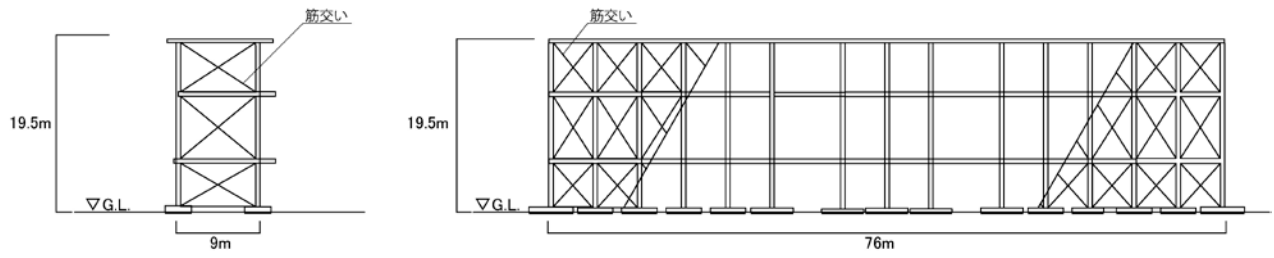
(1) 断面図 (A 設備架台、B 設備架台、F 設備架台)
